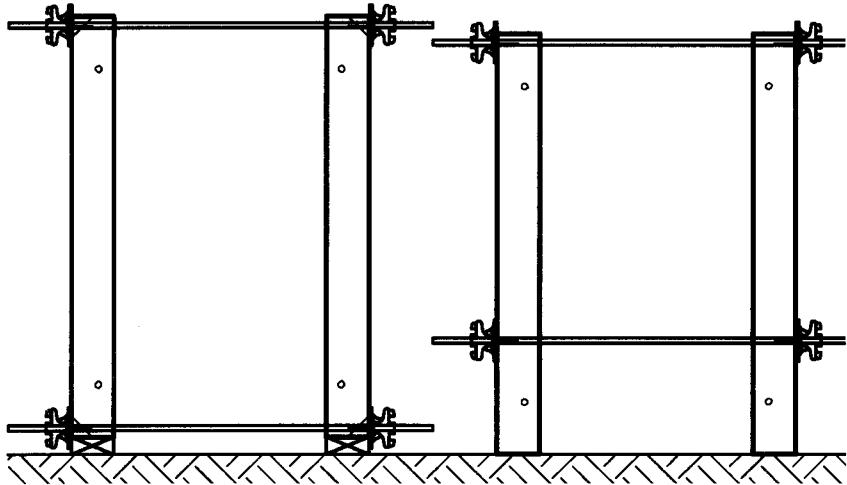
Размещение тяжей в элементах опалубки фундаментов высотой 2,4 и 1,2 м
